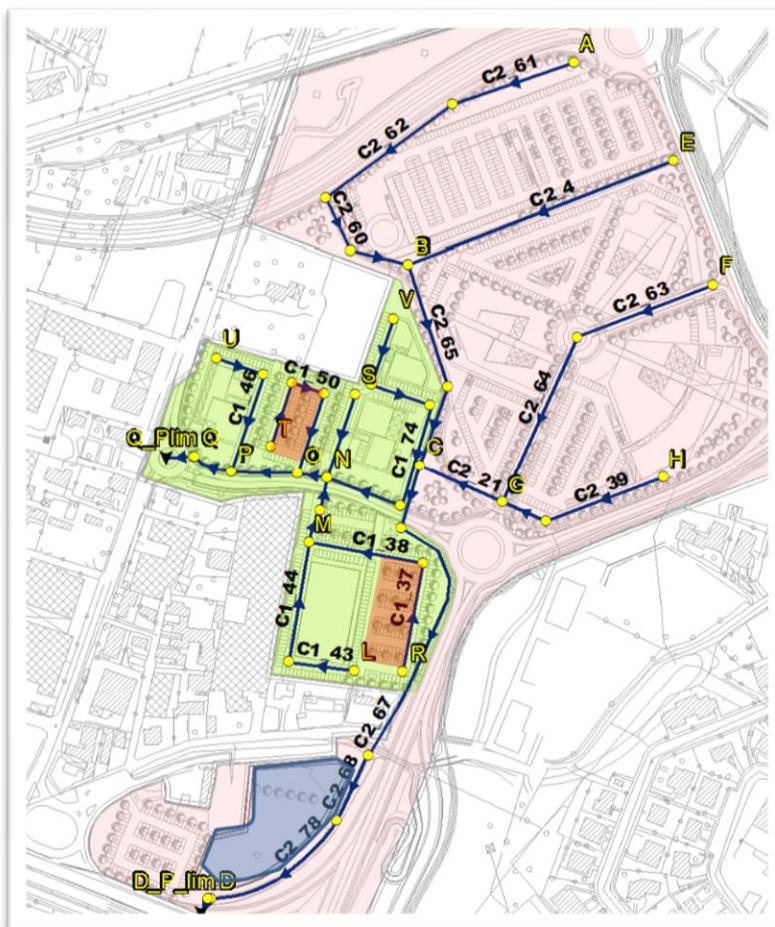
Planimetria Reti di Progetto con codici nome ramo (Cn\_nn)
